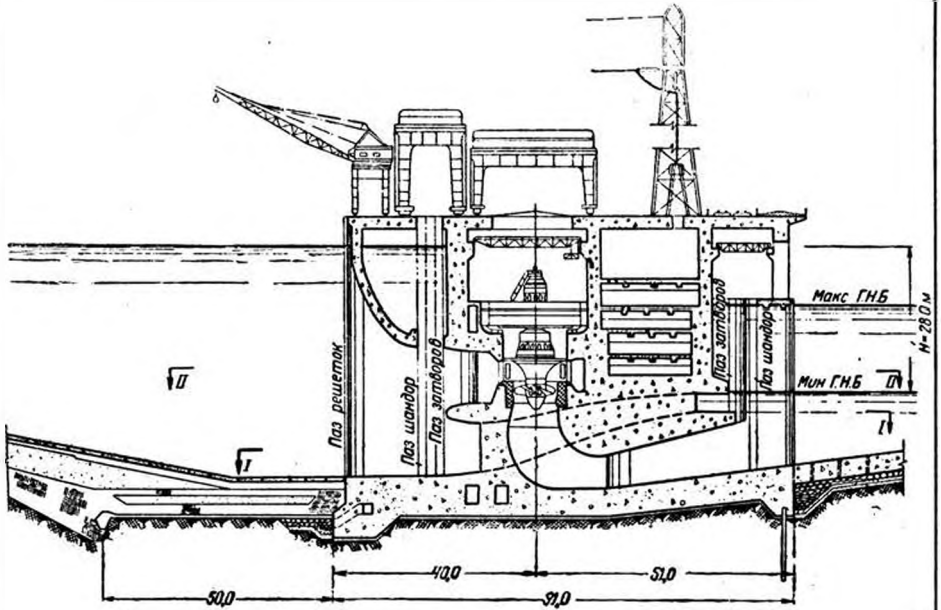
15. Здание ГЭС, совмещенное с сифонным водосбросом
